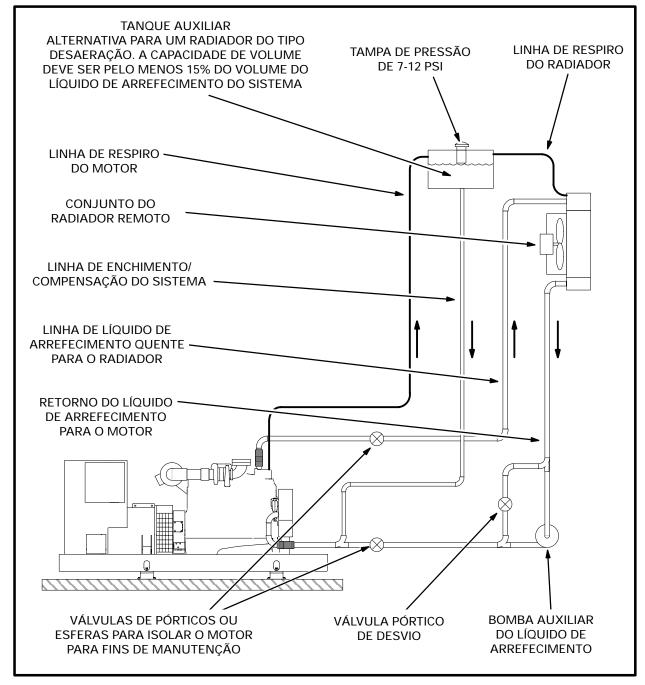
Radiador Remoto com Bomba de Arrefecimento Auxiliar e Tanque Auxiliar
